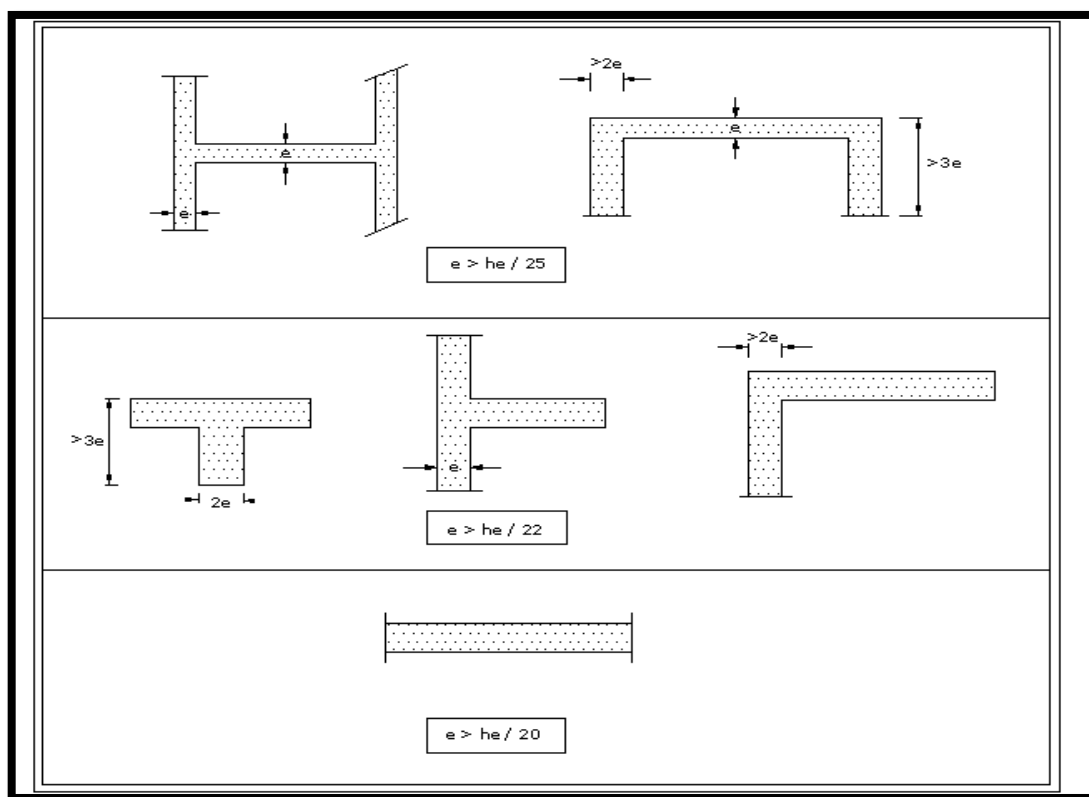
Coupe des voiles en plan RPA99 art 7.7.1
